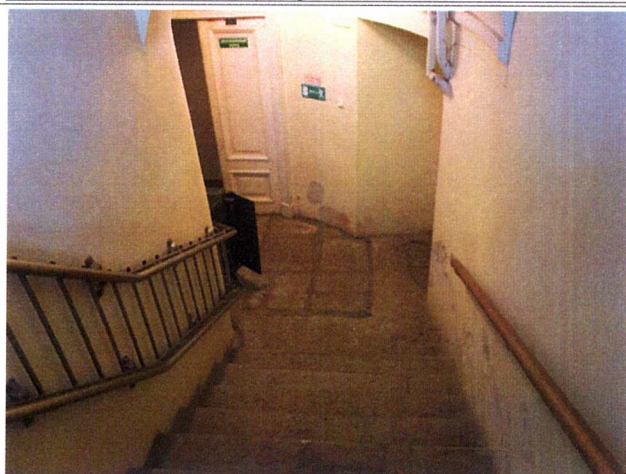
Внутренняя лестница продублированная подъемной платформой с наклонным перемещением до уровня второго этажа
